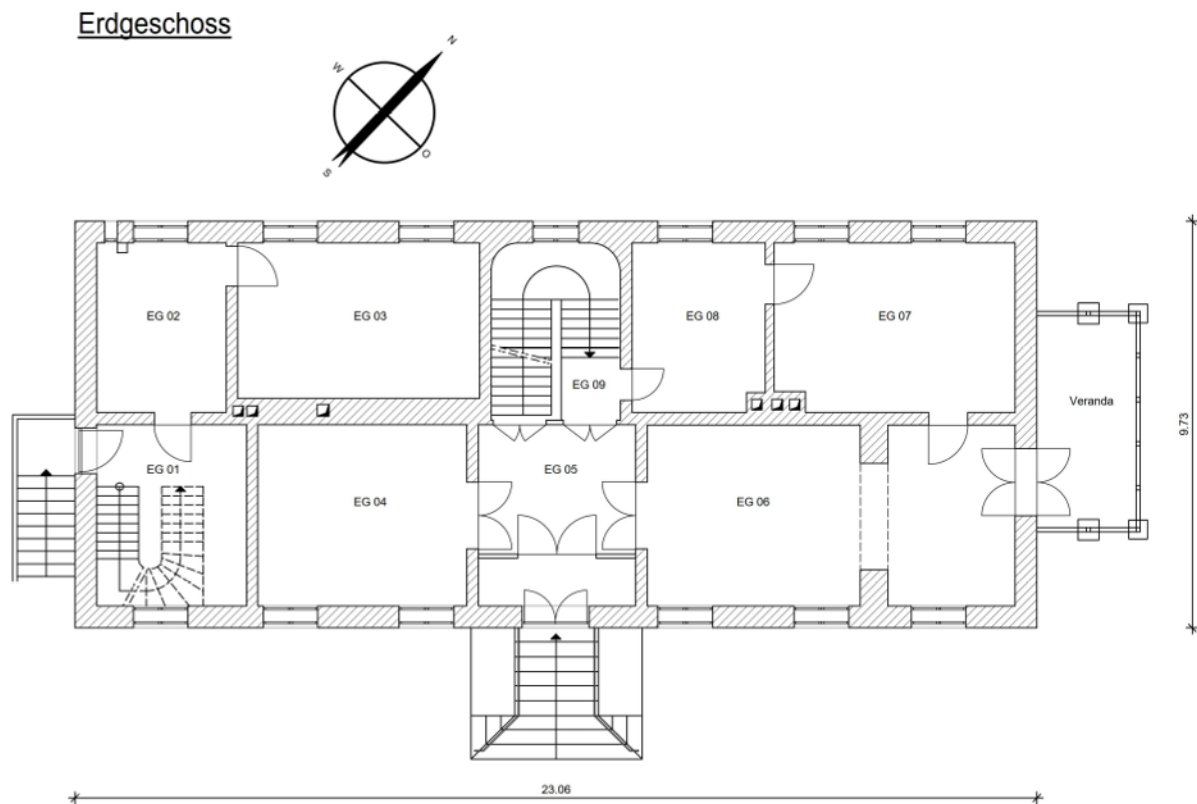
Skizze Grundriss Erdgeschoss
